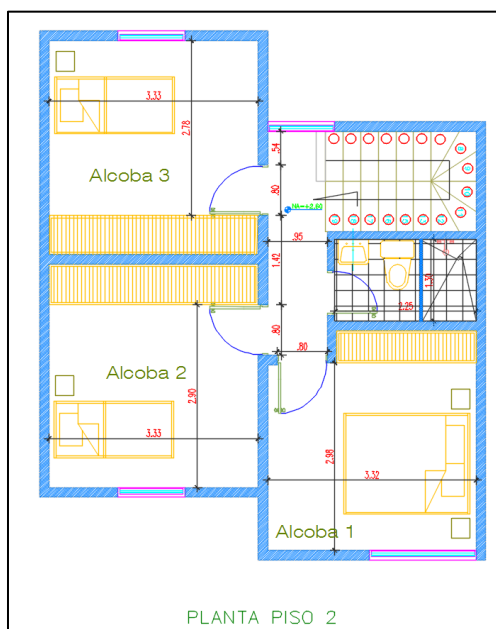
Plano de planta nivel 2. Propietaria de la casa. Fabiola Uribe.
